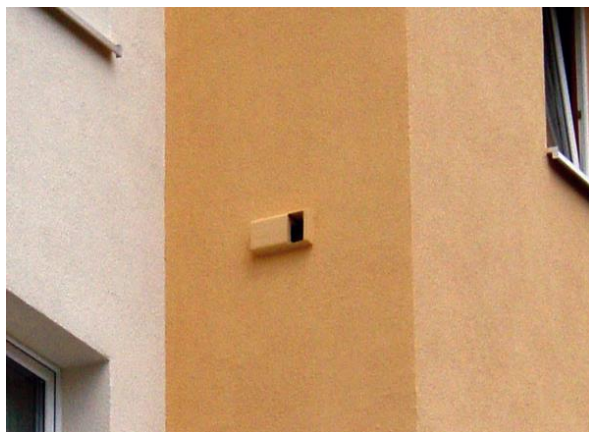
Fassaden-Einbaukasten 1HE, Einbaubeispiel Fassade (Quelle: www.schwegler-natur.de)
